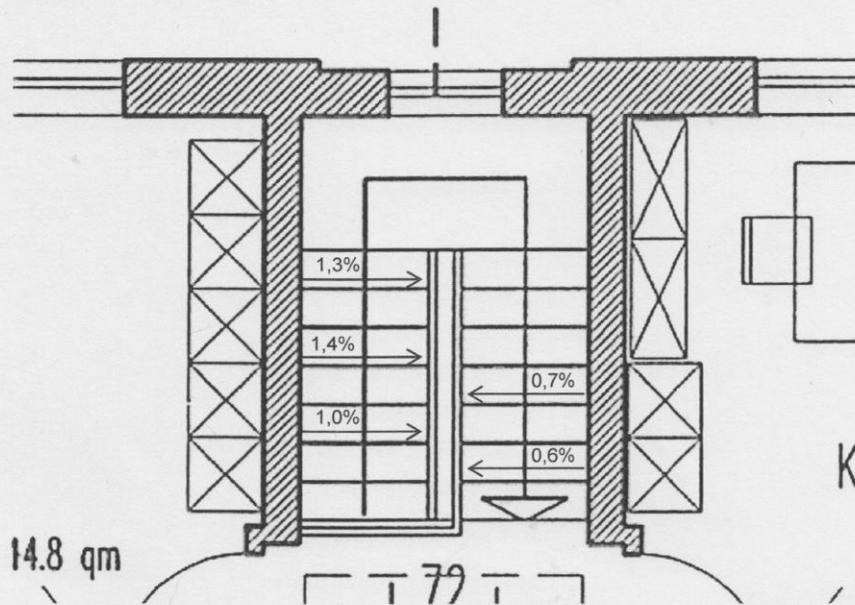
Treppe Erdgeschoss-Obergeschoss, Neigung der Stufen mit Neigungsrichtung rot markiert, Ausschnitt aus Baugenehmigungsunterlage Grundriss Obergeschoss
